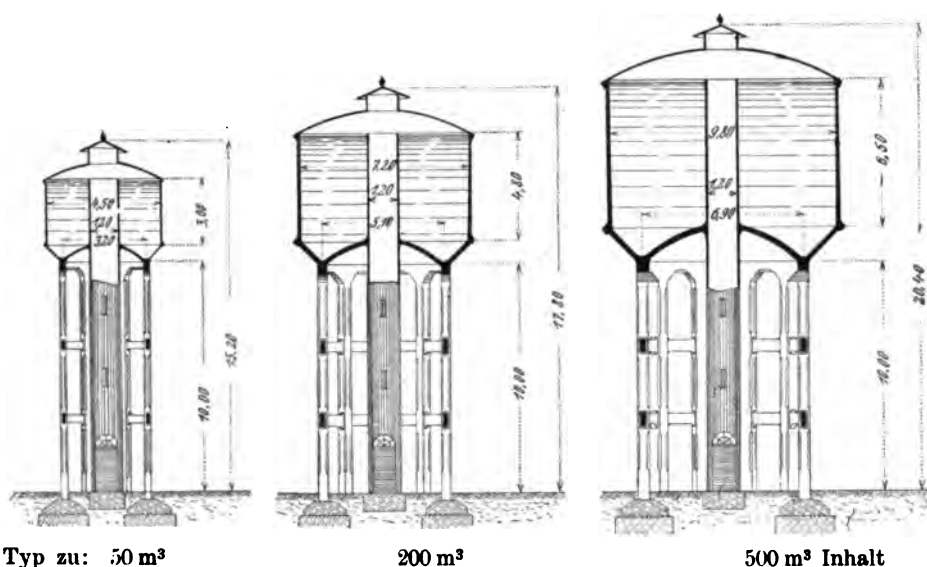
Wasserstationen auf den italienischen Staatsbahnen.
